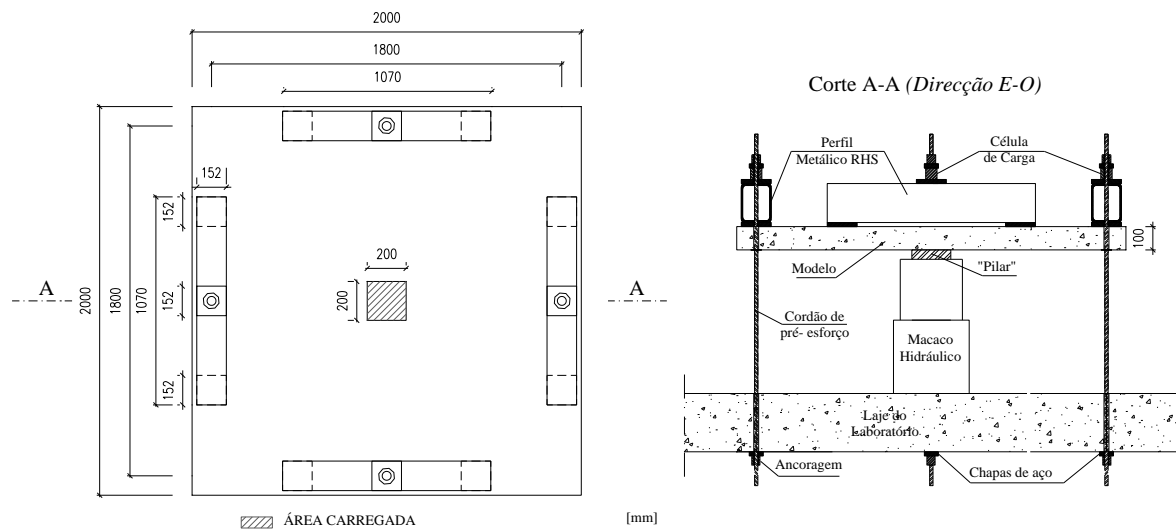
Características geométricas dos modelos PR1 e PR2 – Planta e corte [36]
